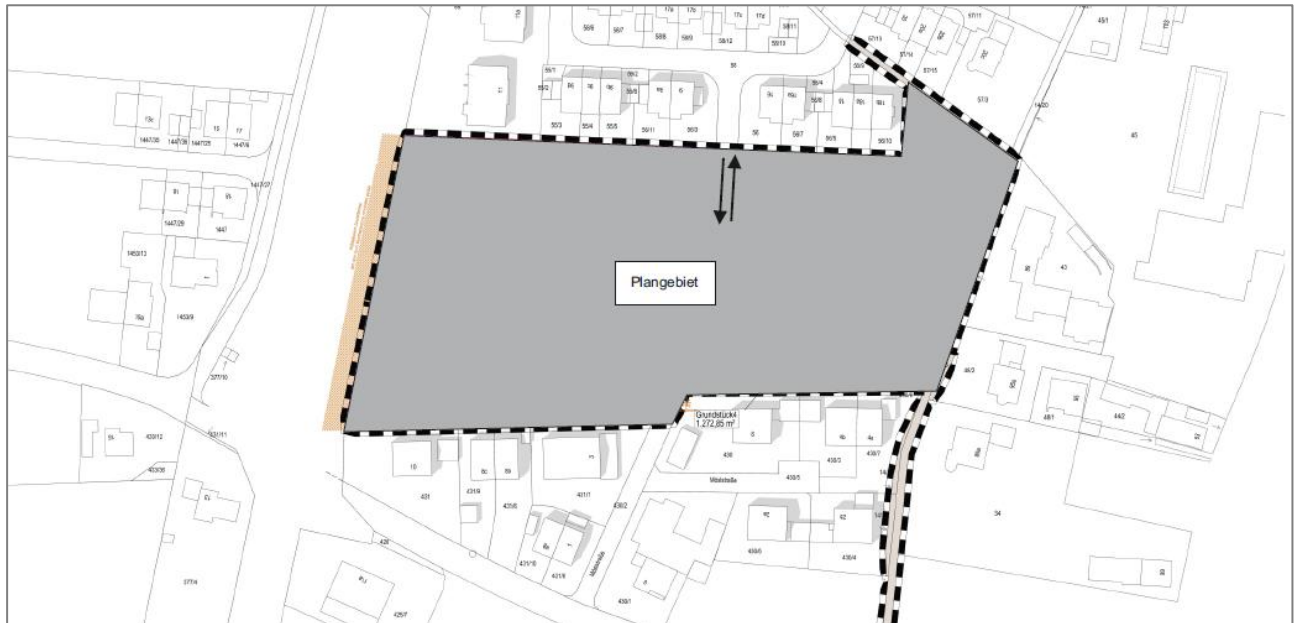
Erschließungsvariante II, Plangrundlage: Planungsgruppe Strasser
